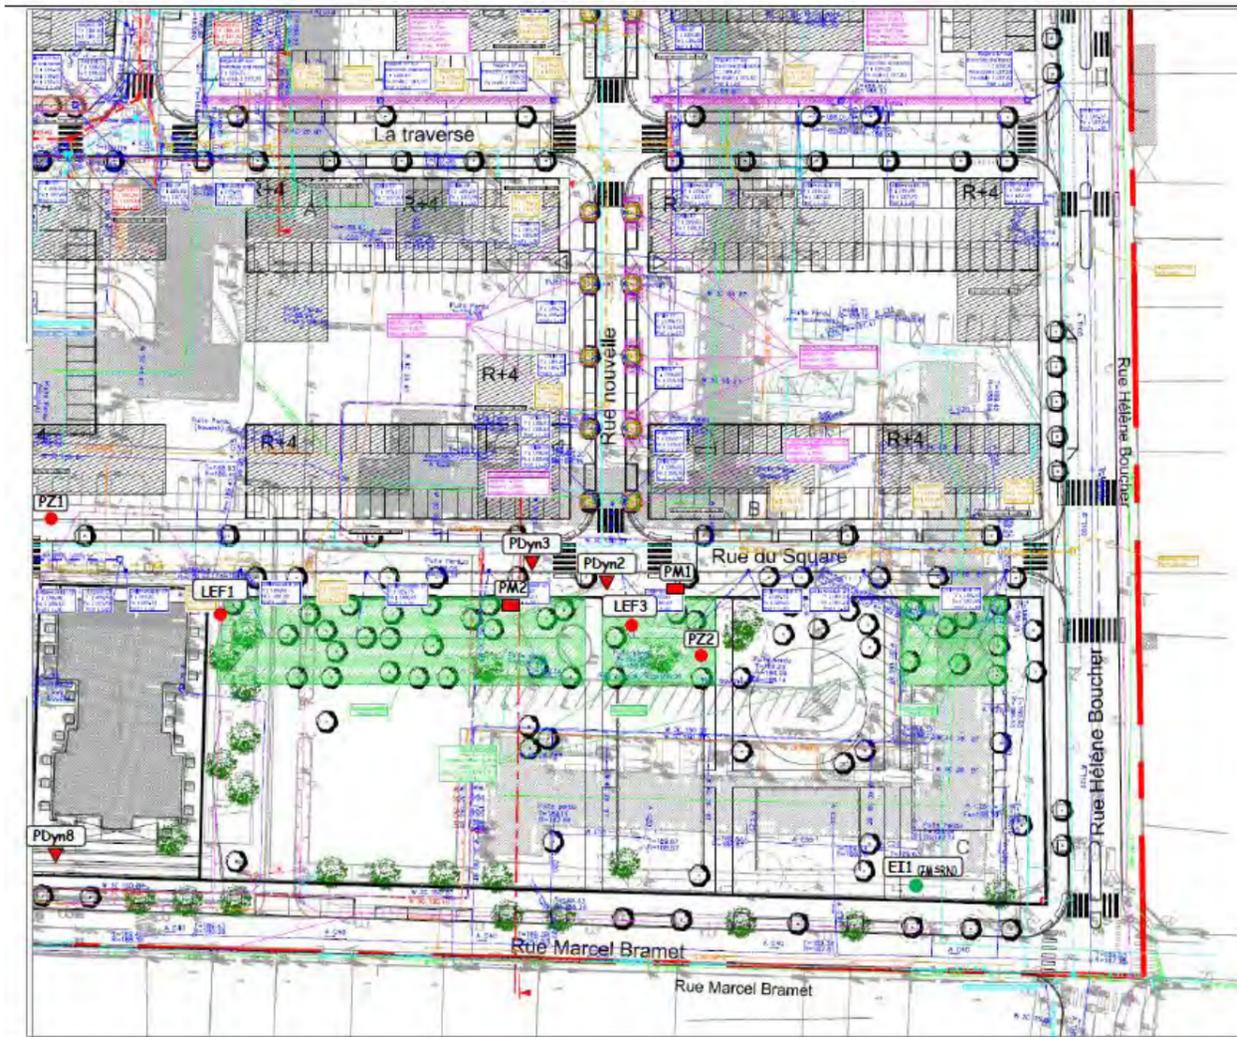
Plan d'implantation des sondages de l'étude FONDASOL d'avril 2017 – secteur Sud
